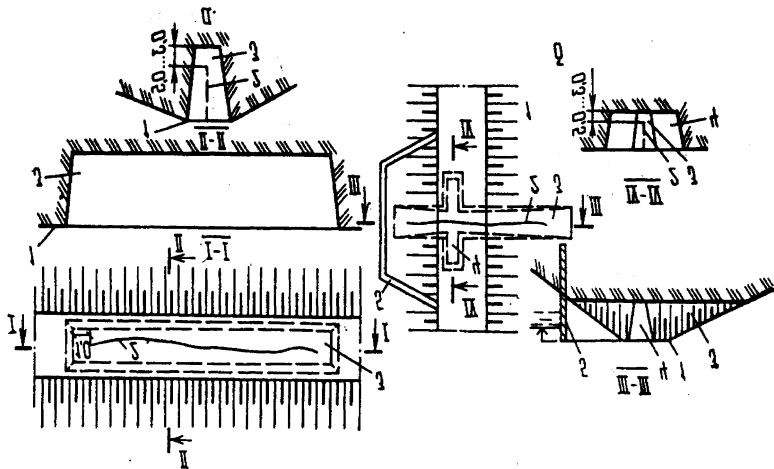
Заделка трещин грунтовых плотин: а – продольной; б – поперечной; 1 – гребень плотины; 2 – трещина; 3 – траншея; 4 – замок траншеи; 5 – шпунтовое ограждение.
